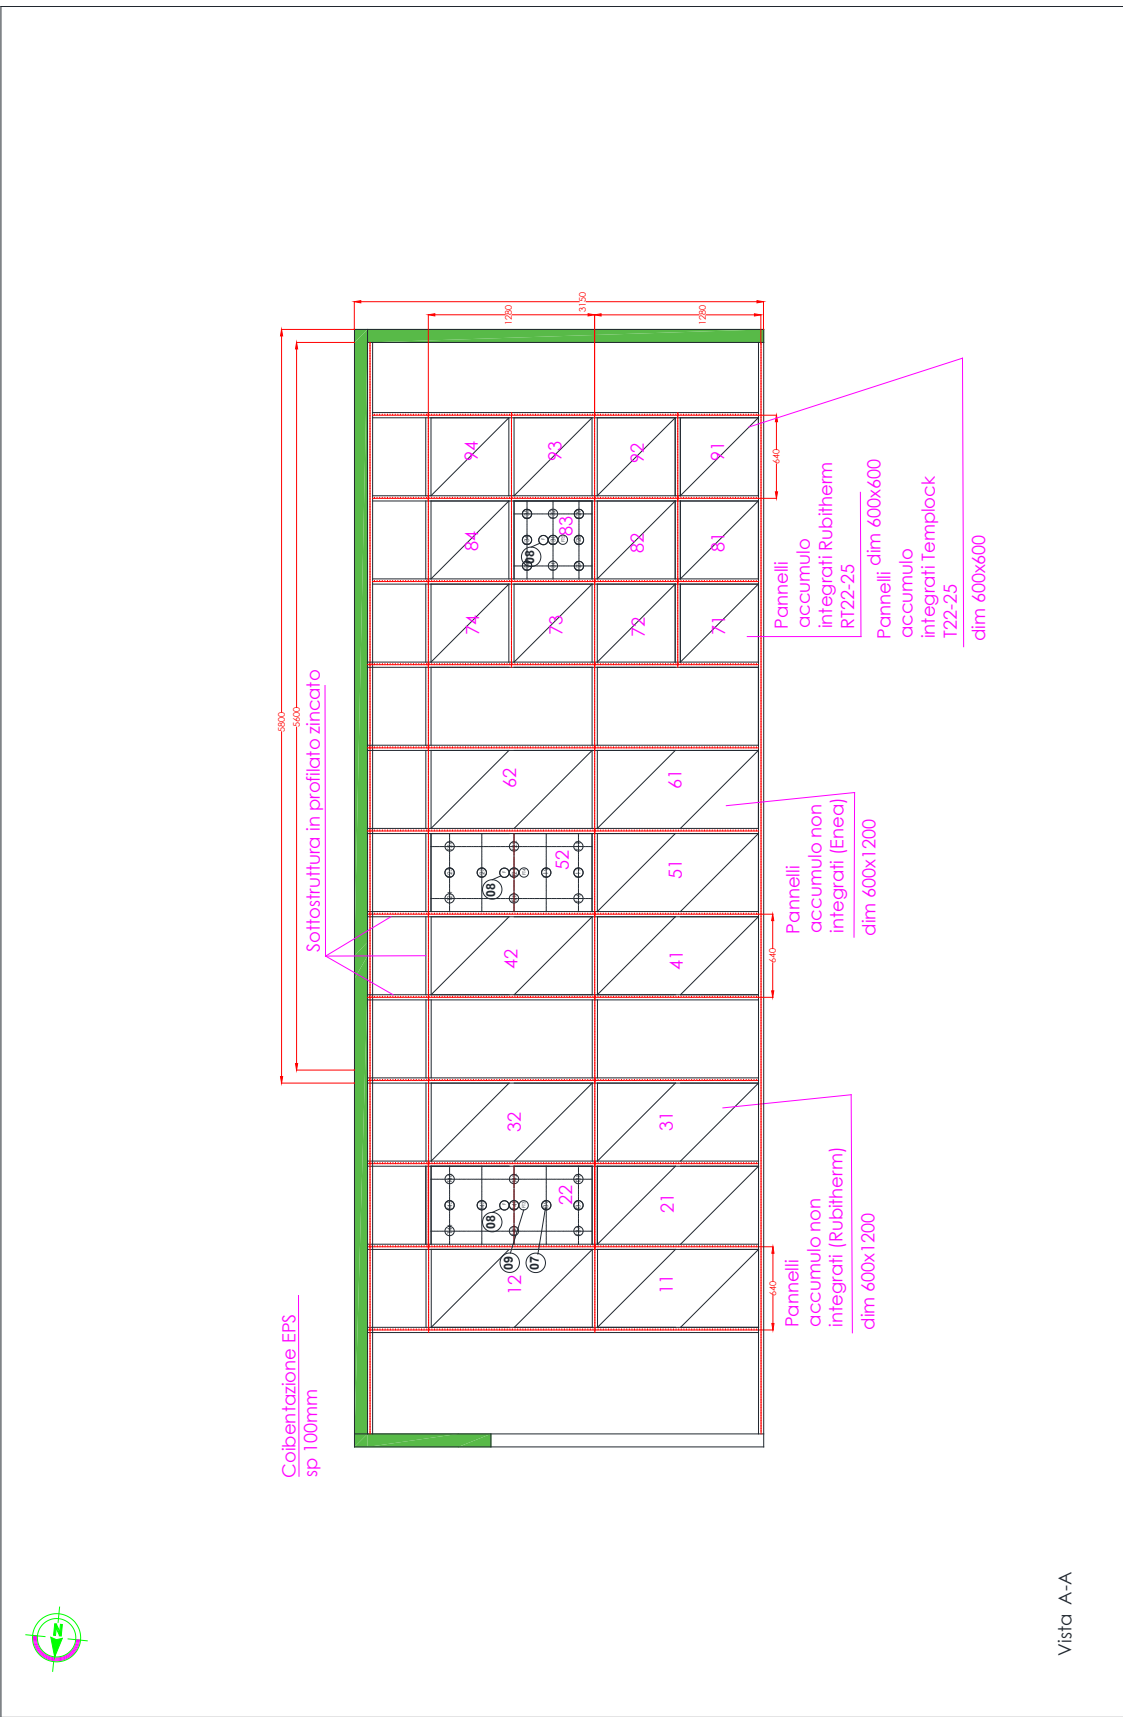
Strumentazione da campo planimetria test rig 1-4
